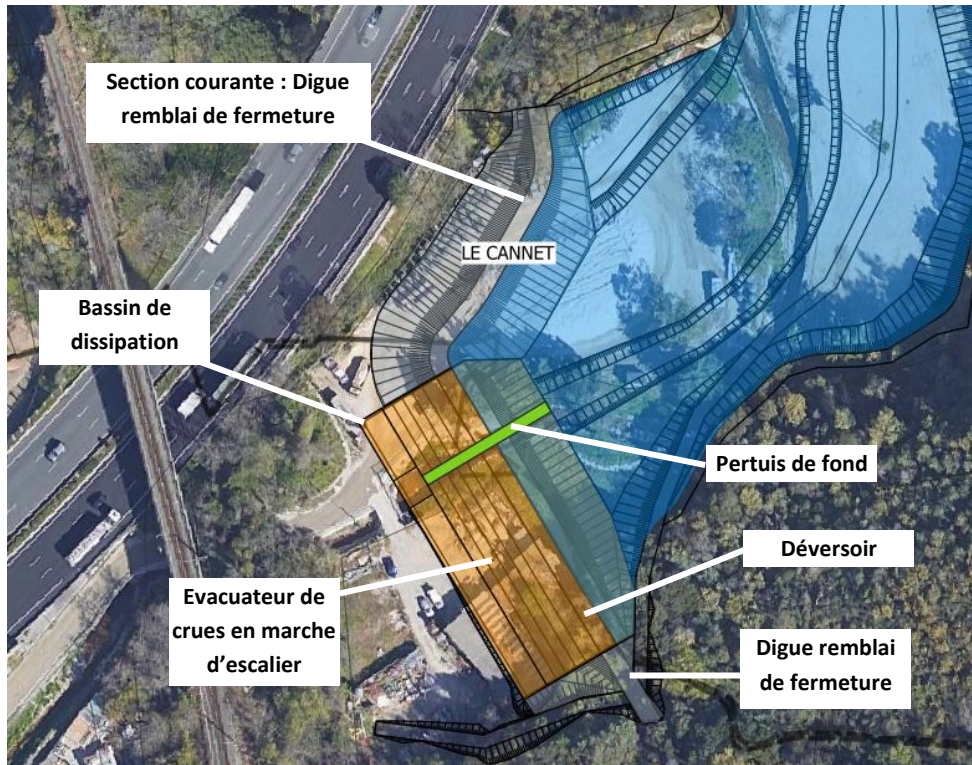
Détail de l'aménagement hydraulique de Carimai – lignes de structures issues du plan AVP (Fond de plan Google Satellite 2023)
